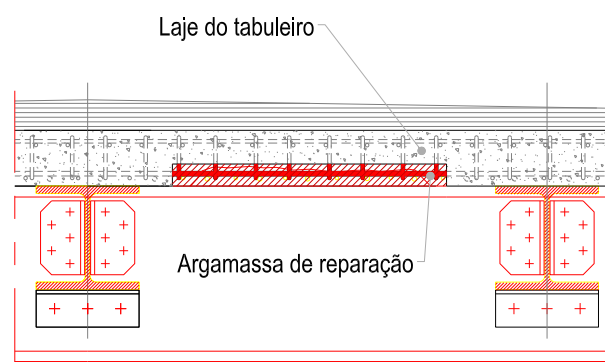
Pormenor da zona de reparação da face inferior do tabuleiro (Fonte: Estradas de Portugal)
